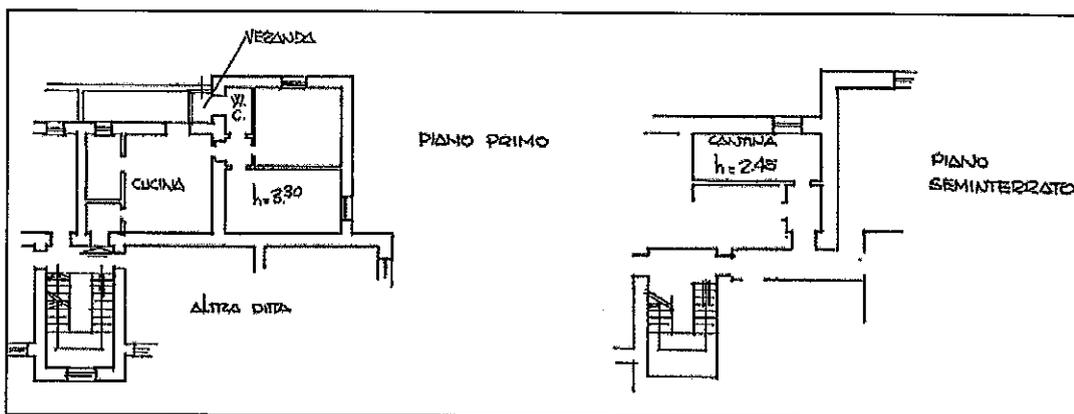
stralcio della planimetria catastale part. 219 sub 7 (abitazione di tipo popolare)
